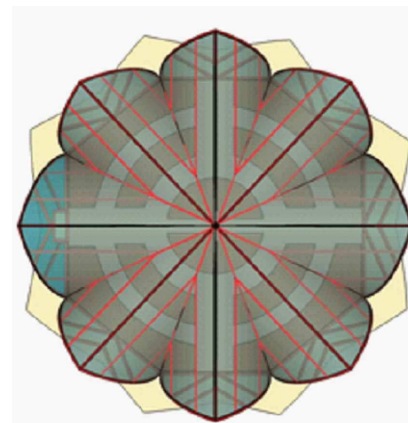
Vista en planta del diseño final del vivero. Fuente: Propia
